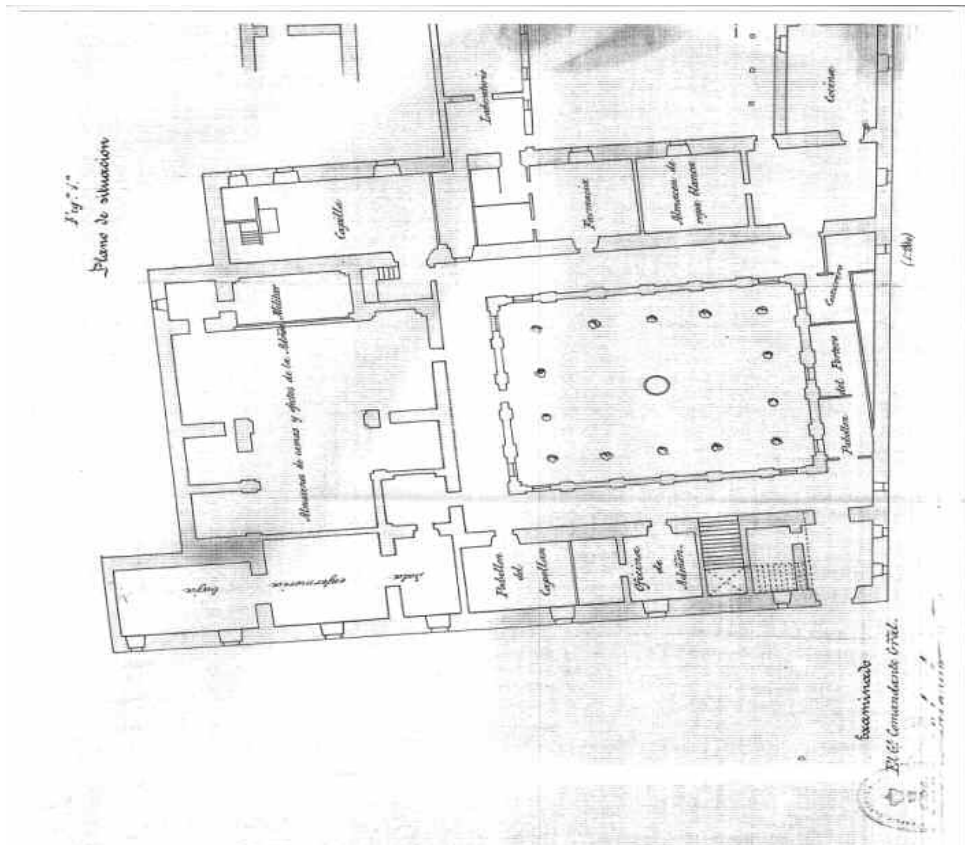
Planta baja H. militar. 1900. Ubicación de la farmacia. A.G.M.A.
